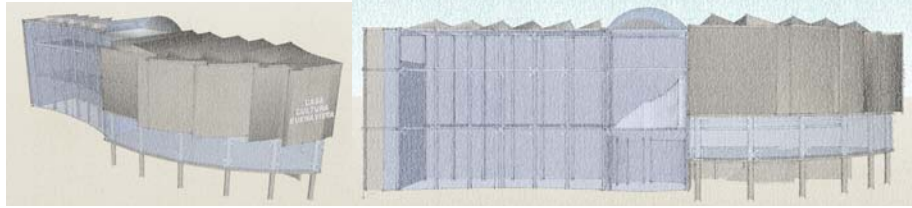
PRIMERA PERSPECTIVA Y FACHADA C.C.B
